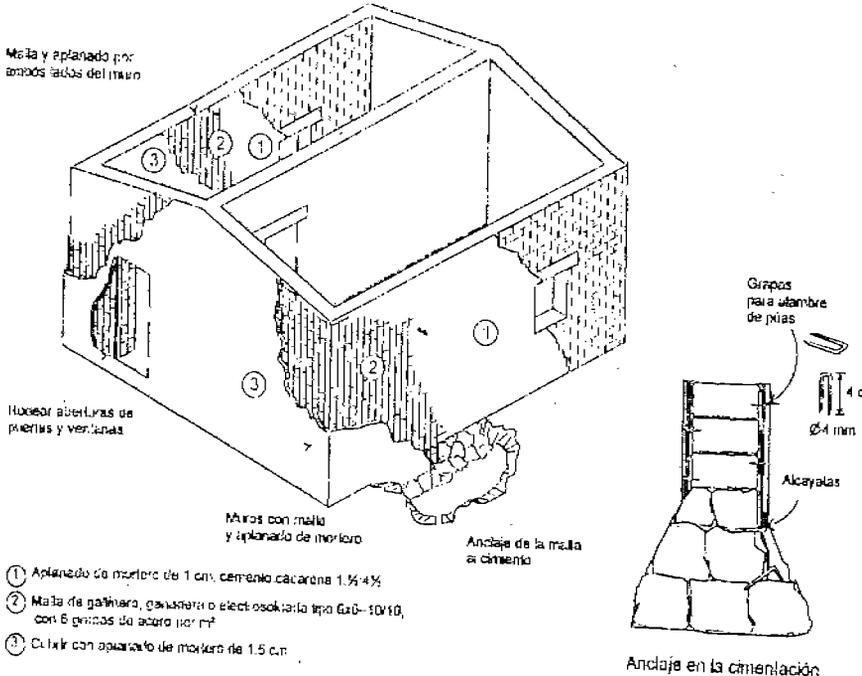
ENCAMISADO DE MUROS DE ADOBE CON MALLAS METÁLICAS RECUBIERTAS CON MORTERO.
